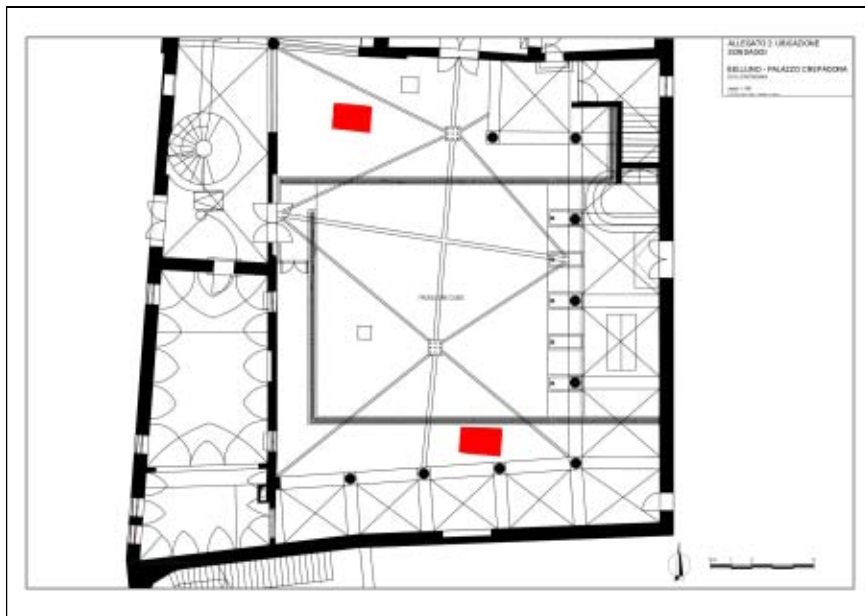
Planimetria di Palazzo Crepadona con posizionamento dei sondaggi all'interno del cortile.
